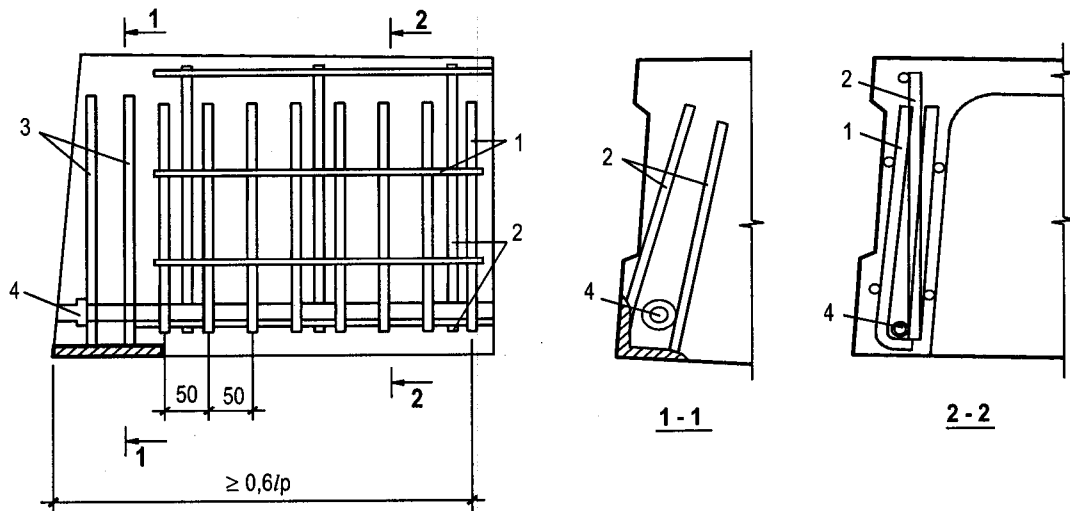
Bố trí cốt thép tại các đầu dầm ứng suất trước
